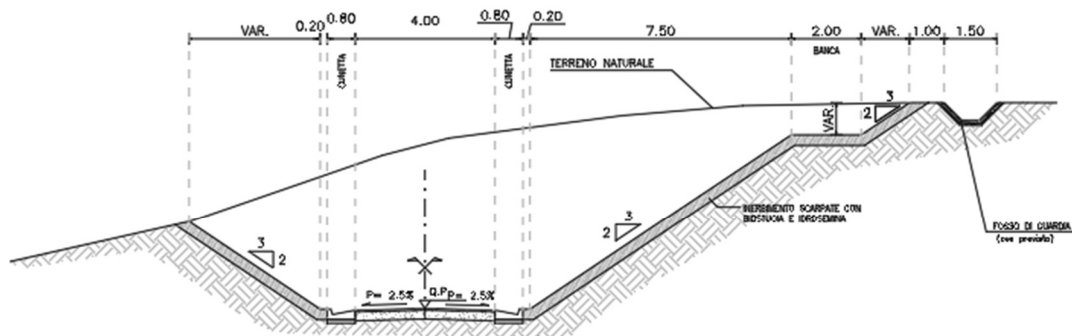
sezione tipo strade a destinazione particolare in trincea
